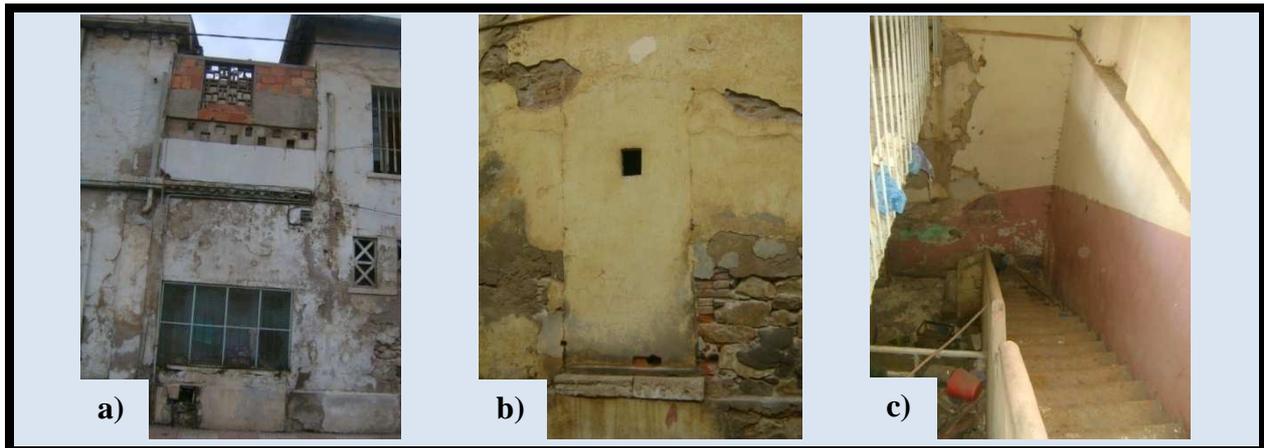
Photos des modifications de l'architecture originelle ; a) La nouvelle maçonnerie, b) La condamnation de fenêtre, c) L'escalier en béton à l'emplacement d'escalier en bois, source : l'auteur.
